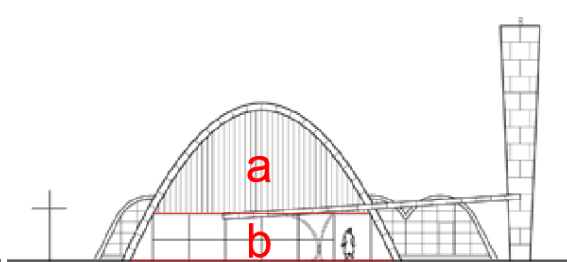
Fachada Principal. Fonte: Adaptada[6]
